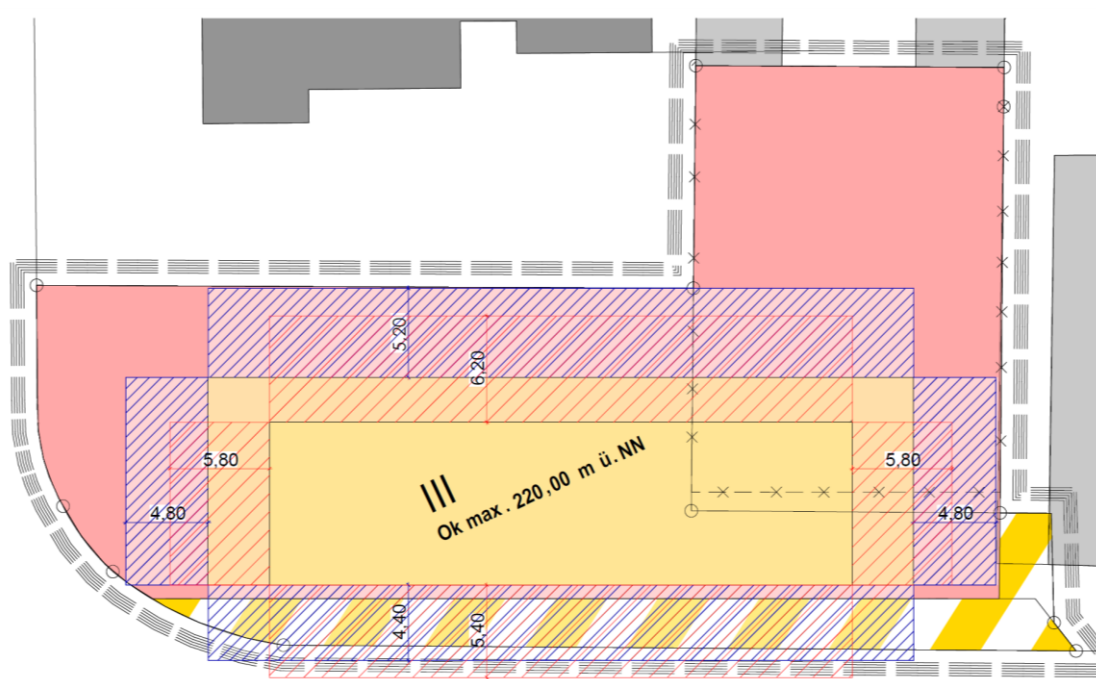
Darstellung Abstandsflächen auf dem Grundstück (Blaue Schraffur = Abstandsflächen Vollgeschosse, rote Schraffur = Abstandsflächen Staffelgeschoss)
